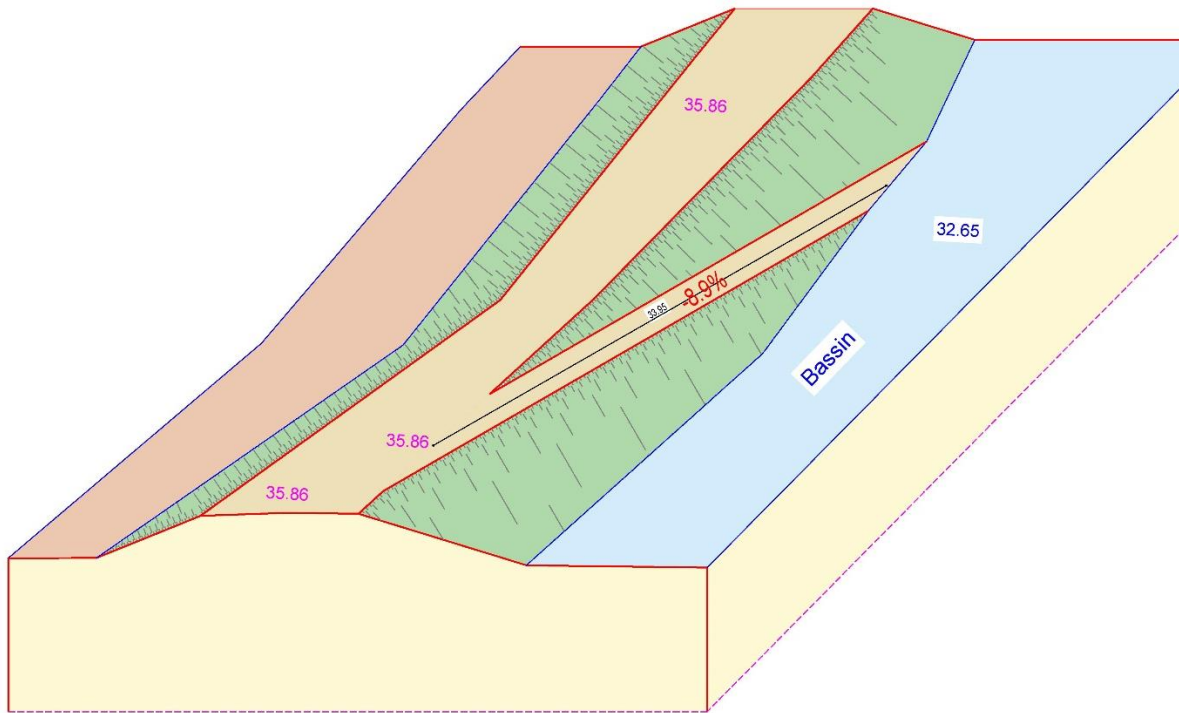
Plan et coupe de la rampe d'accès au bassin de compensation
